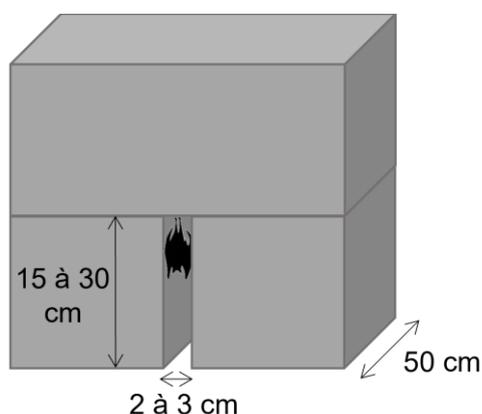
Représentation en coupe d'un rainurage créé entre deux modules de l'ouvrage
